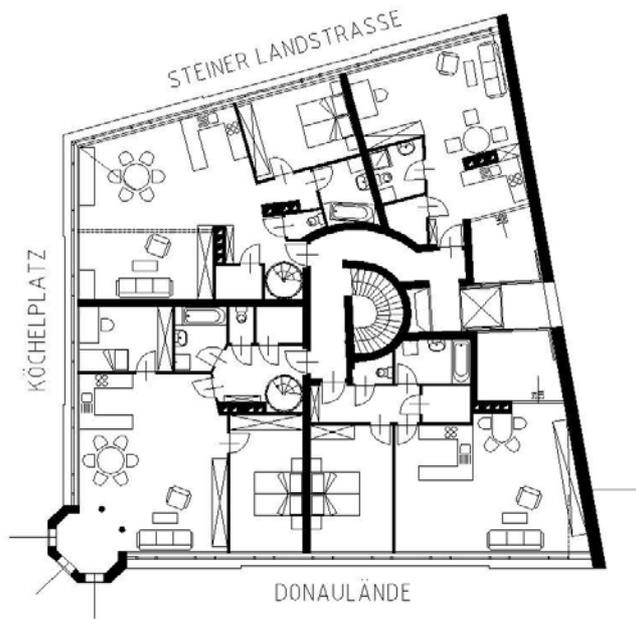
Grundriss Dachgeschoss neu
